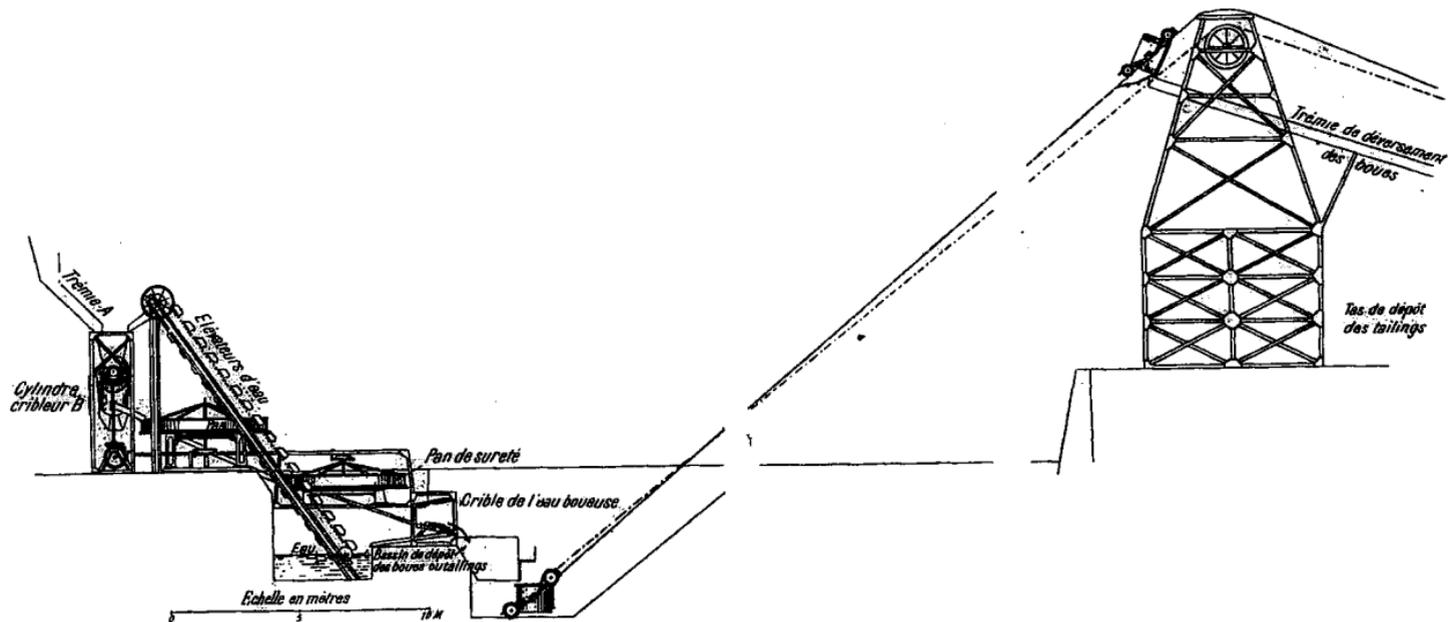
Disposition des ateliers de lavage en coupe verticale.
